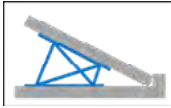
Stützen mit schwenk- und drehbaren Fussplatten aus dem Bau-, Gerüstbau- und Rettungssektor
